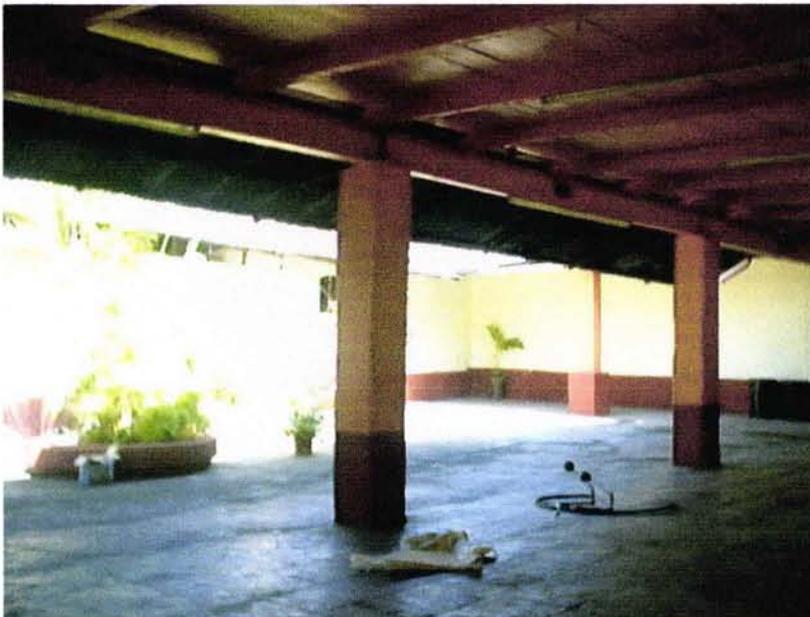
Columnas de madera en el pórtico de acceso.
